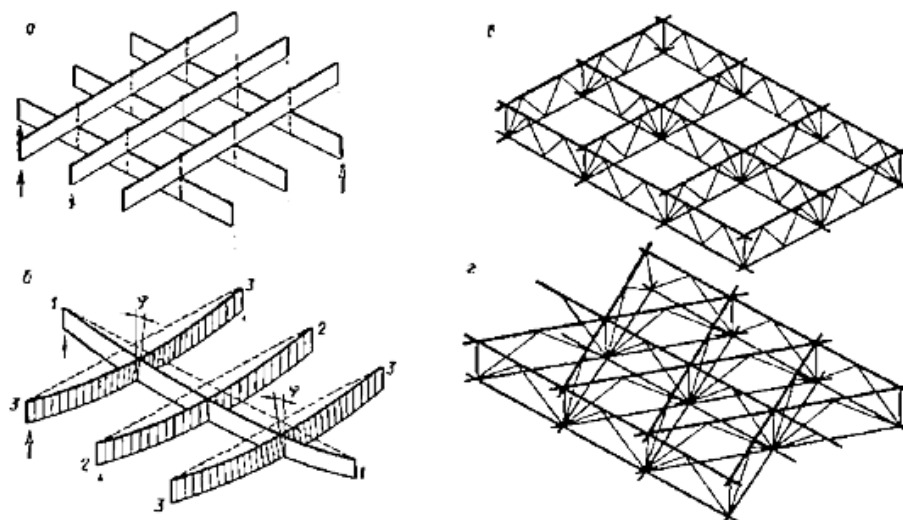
а – этажное расположение балок; б – картина деформации из балок; в – ортогональная сетка перекрёстных форм; г – треугольная сетка перекрёстных форм
